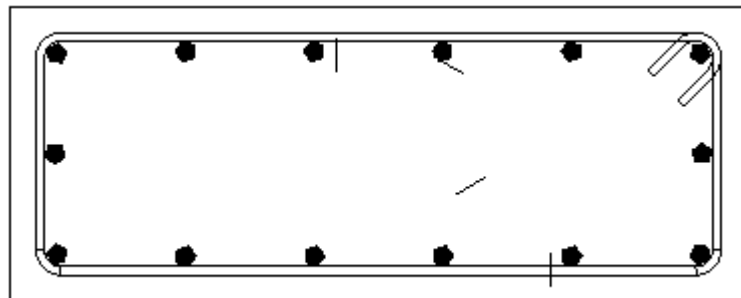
Pormenor da amarração das armaduras transversais de um pilar recorrendo à Autodesk Revit 2013 em planta
